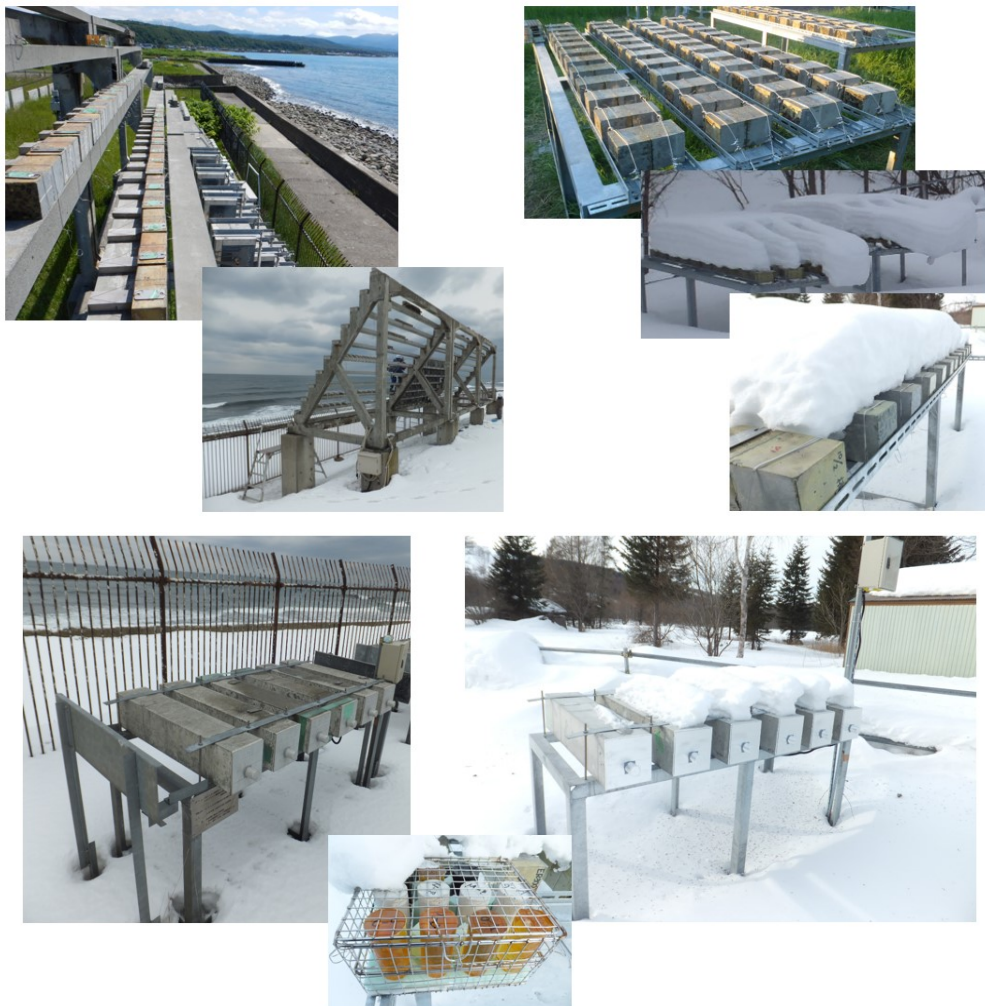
各暴露場とひび割れ修復供試体の暴露状況例
